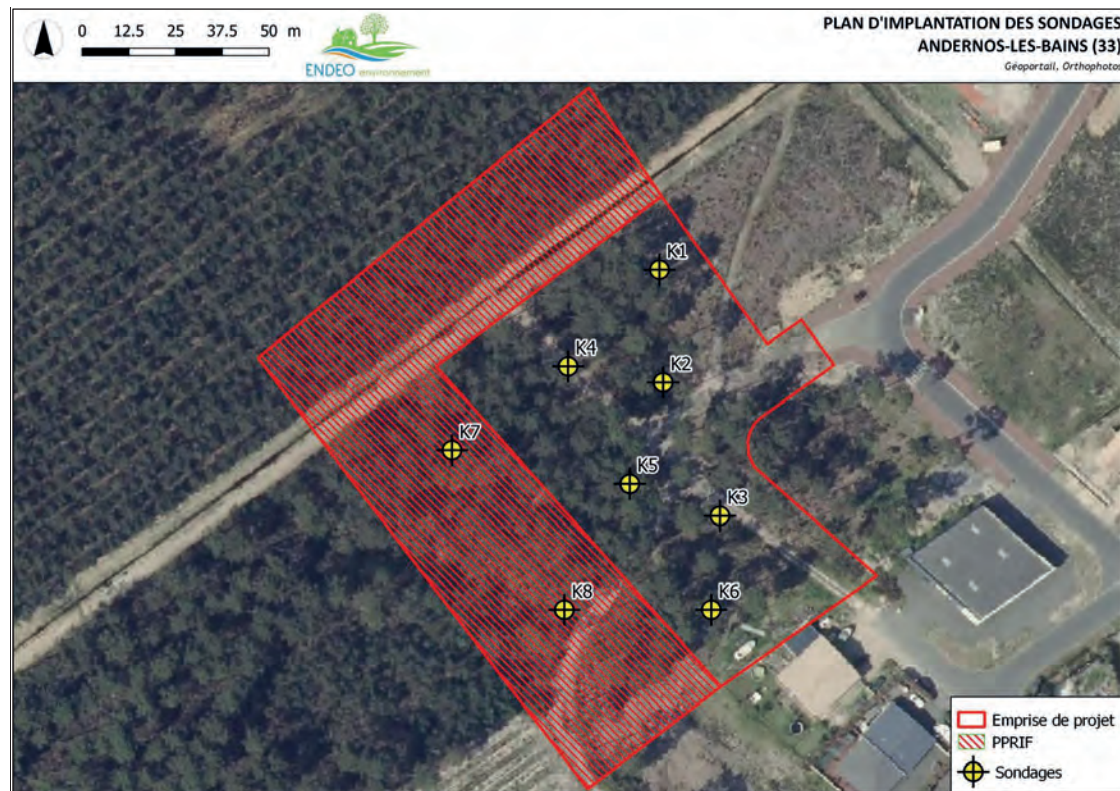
Plan de localisation des sondages et essais (ENDEO Environnement)
